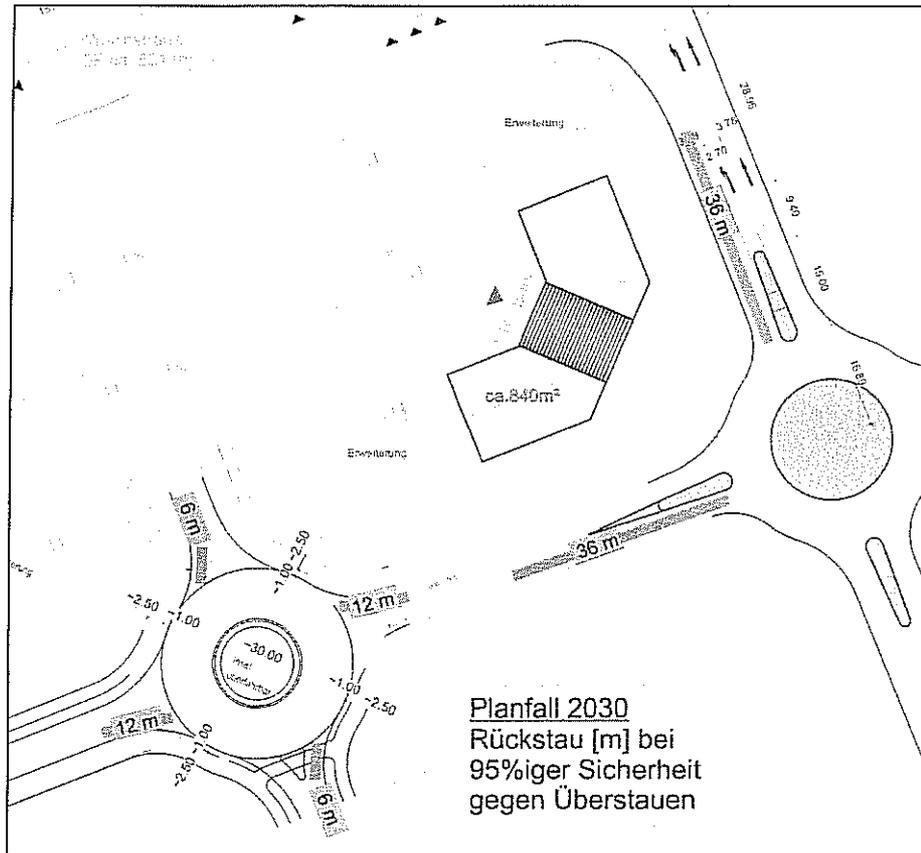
Rückstaubetrachtung - Planfall 2030, MSV_w
